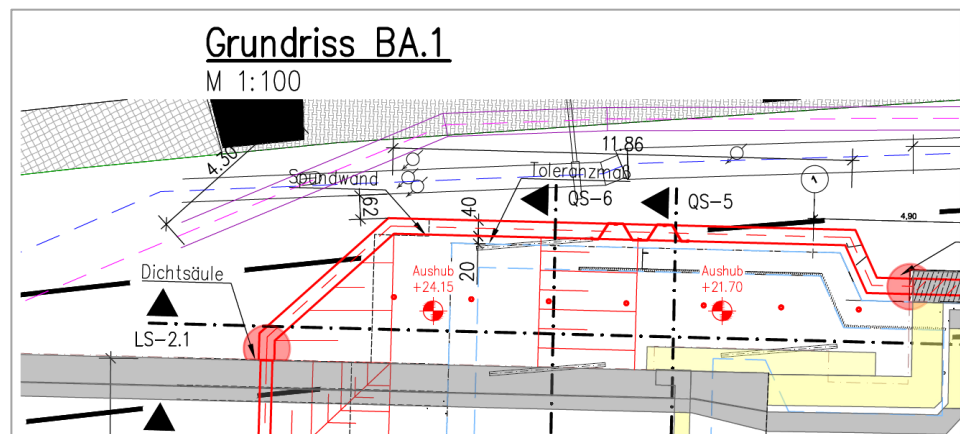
Ausschnitt Planung Baugrube (unmaßstäblich)
